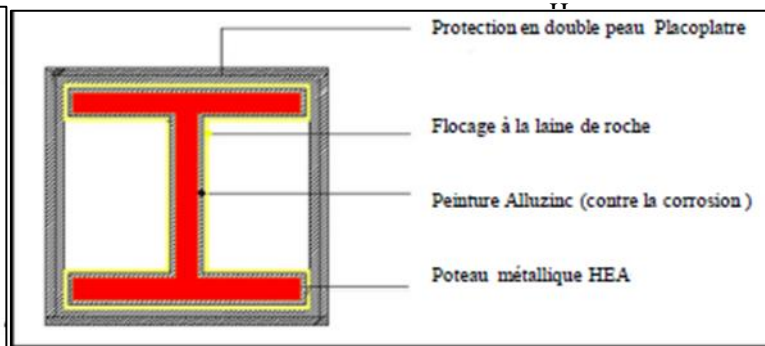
Protection du poteau contre la corrosion et le feu
